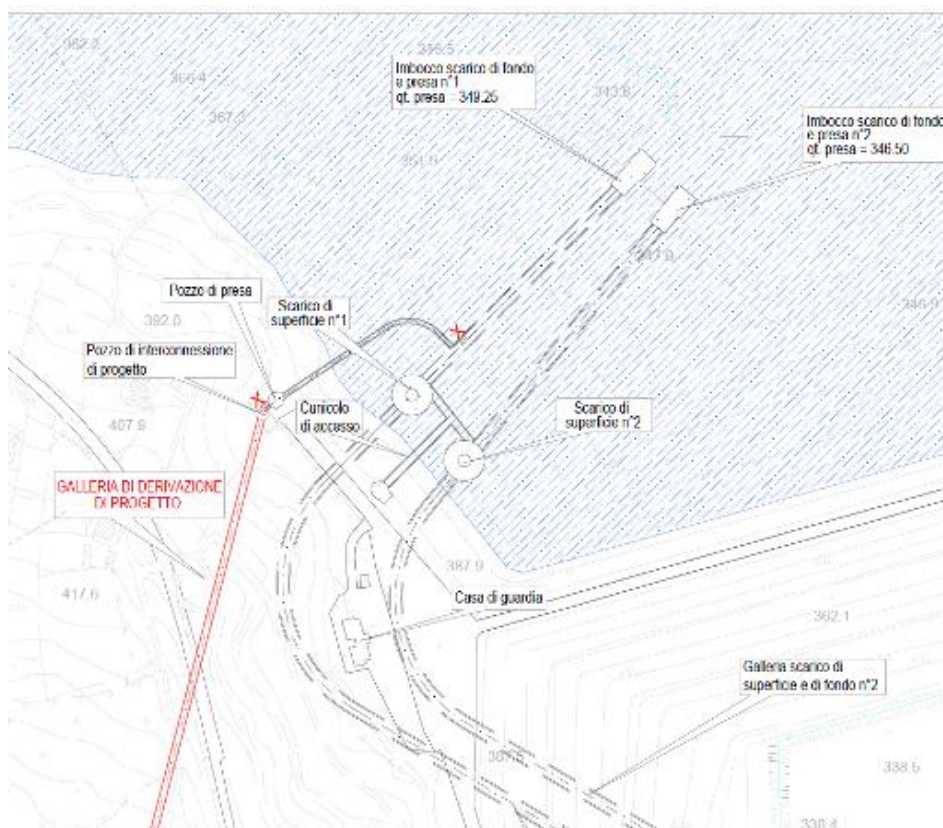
Planimetria ubicazione del pozzo di interconnessione
